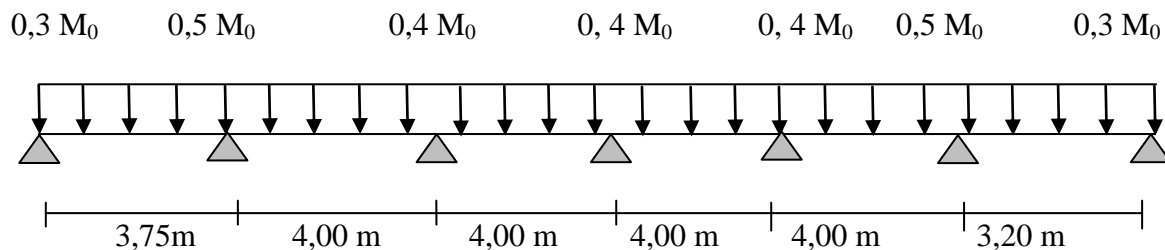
schéma statique d'une poutre sur plusieurs appuis
